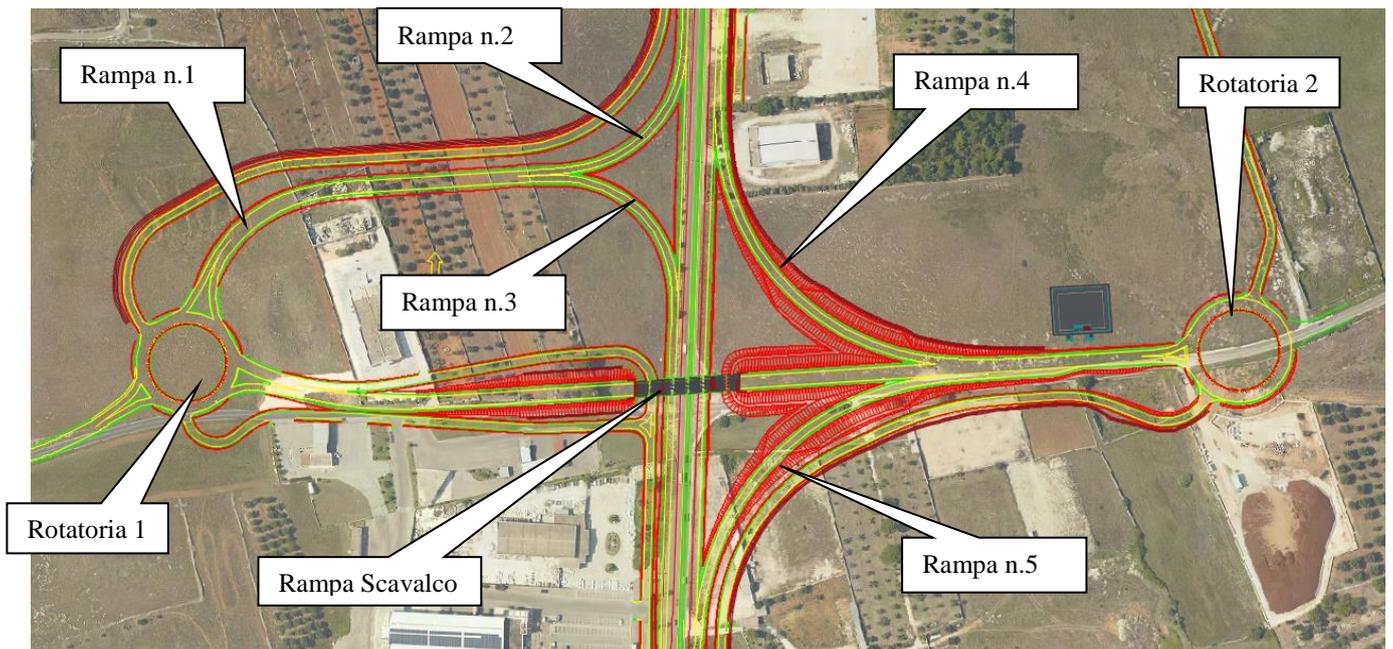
Svincolo 10 – SURANO – RUFFANO configurazione di progetto
